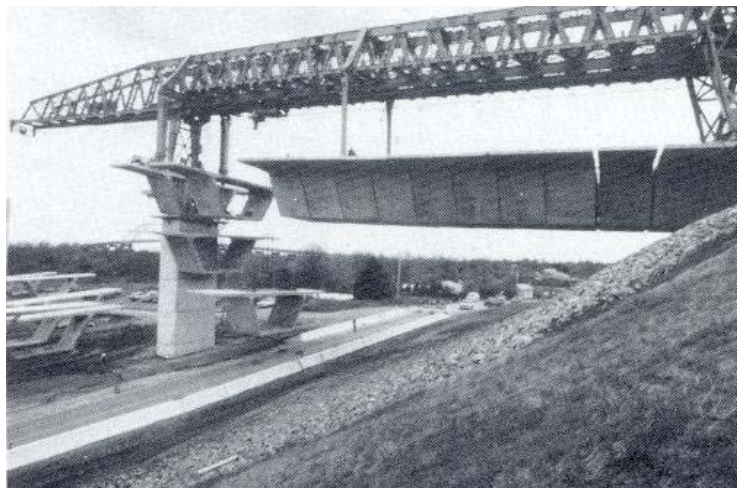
Construcción de un puente de dovelas con junta seca [CORVEN(1993)].
